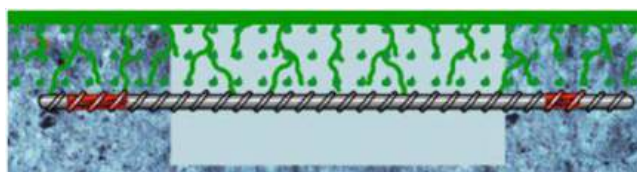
Difusão na fase de vapor através dos poros do concreto e de fissuras superficiais.
